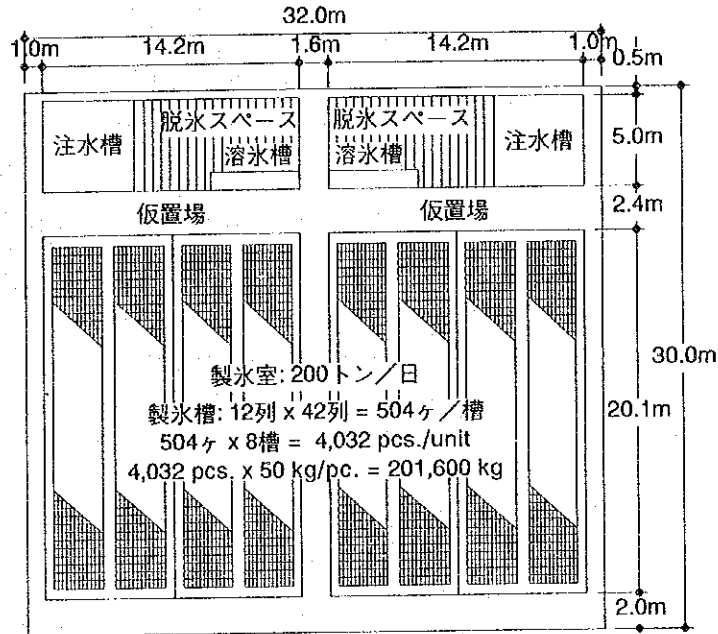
製氷室の概略平面図 (床面積 960m<sup>2</sup>)
